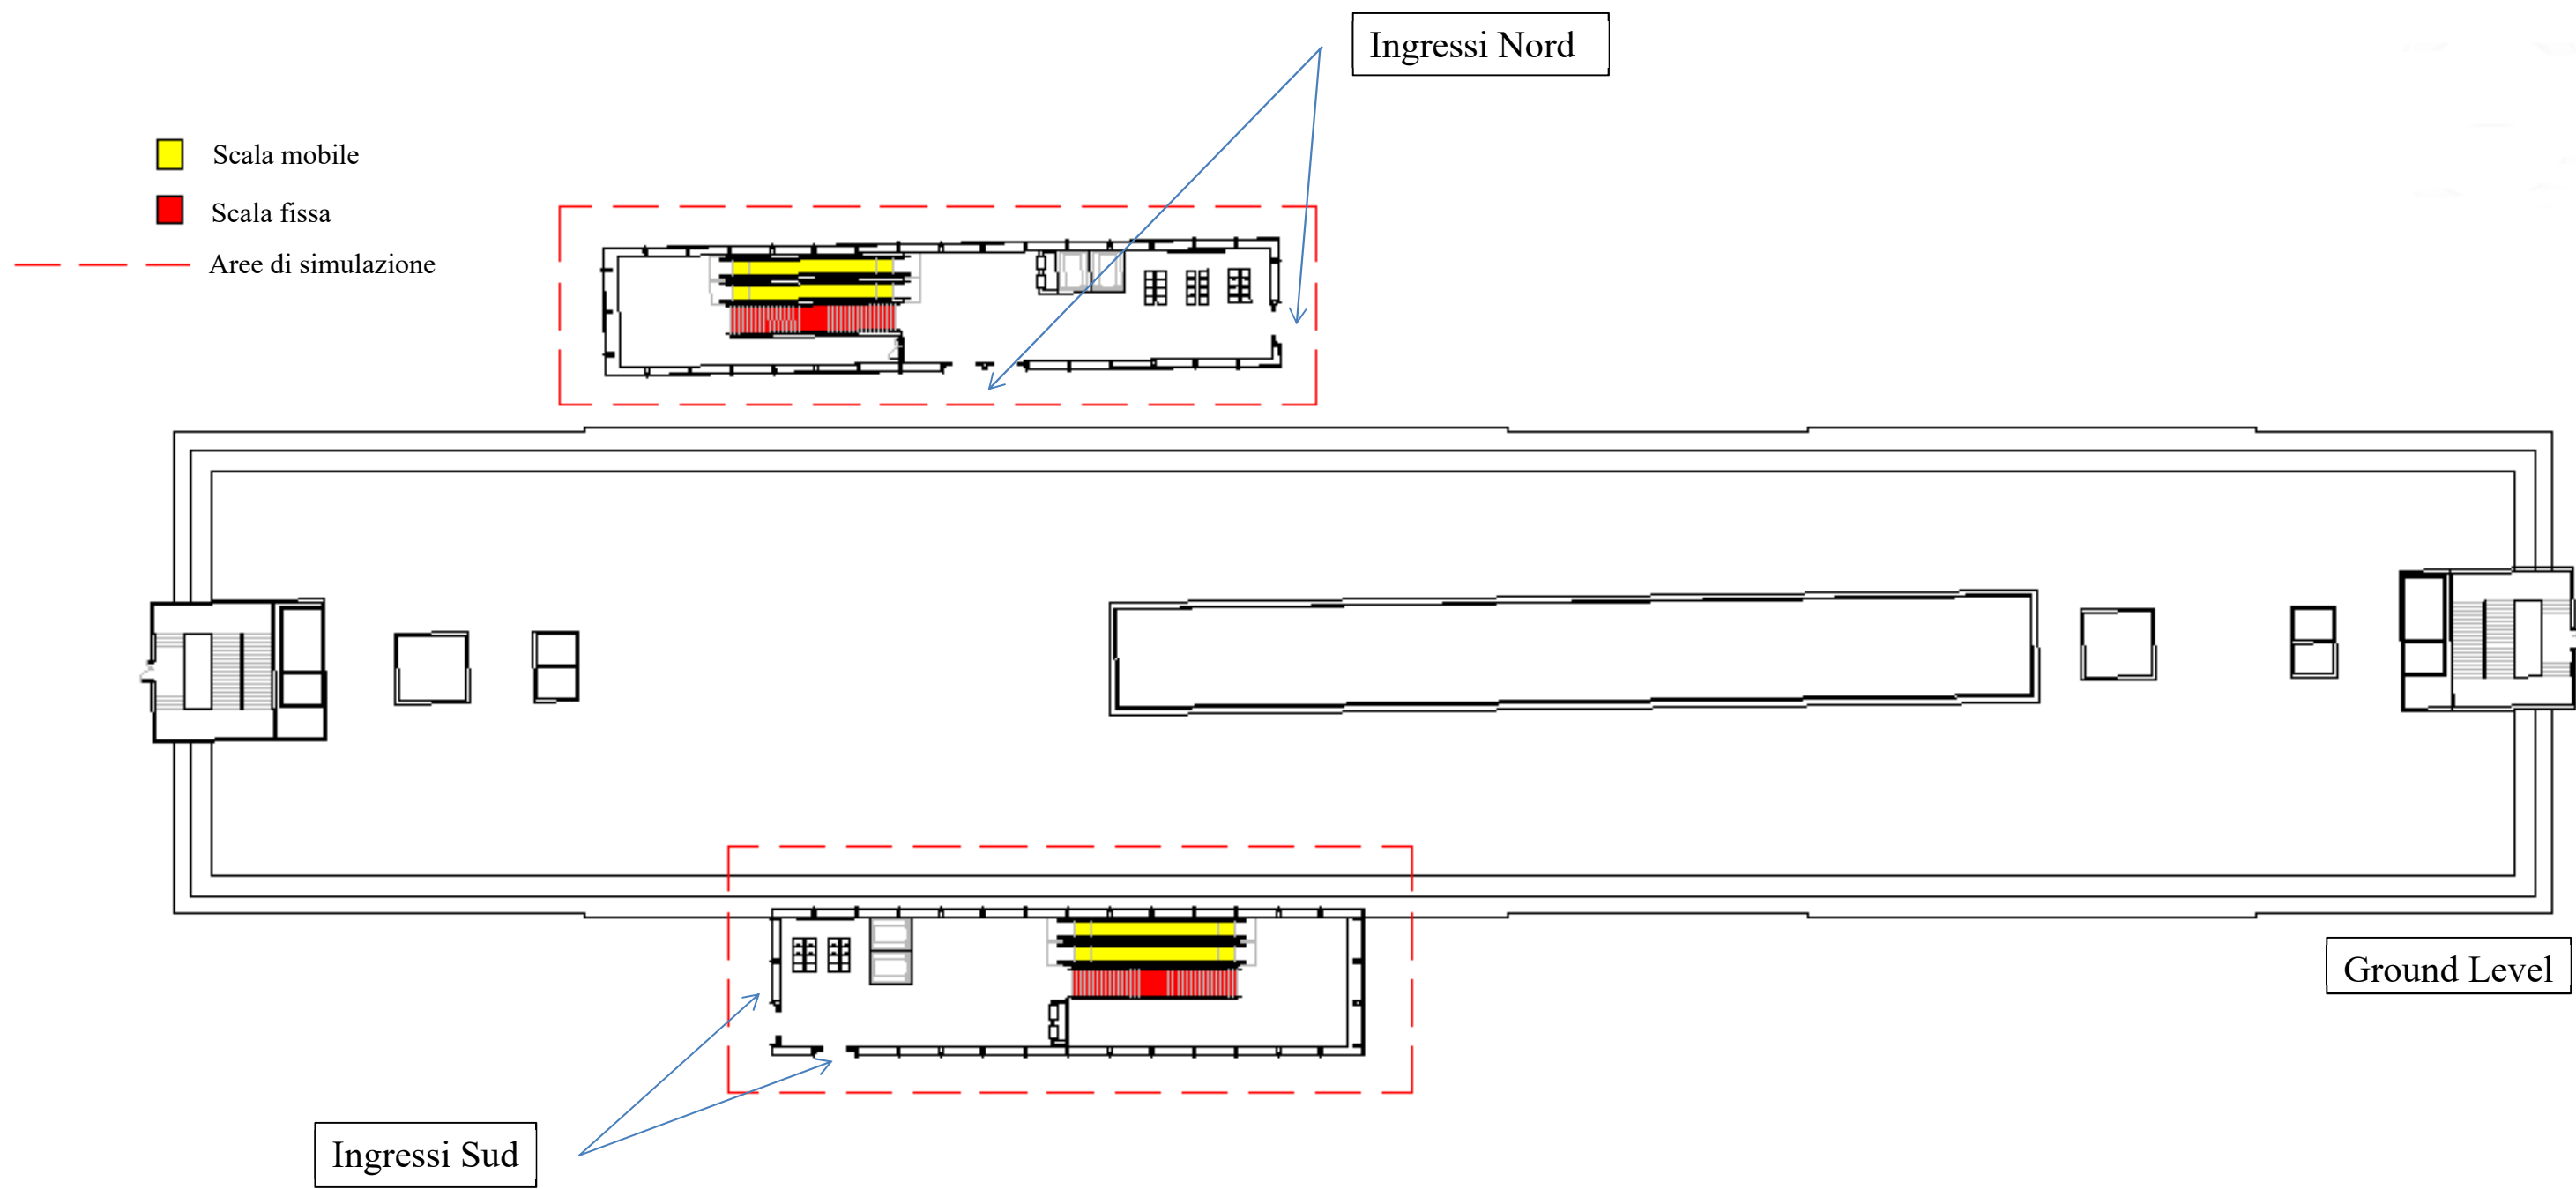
1: geometrie CAD del Ground Level della Dubai Investment Park Station.
